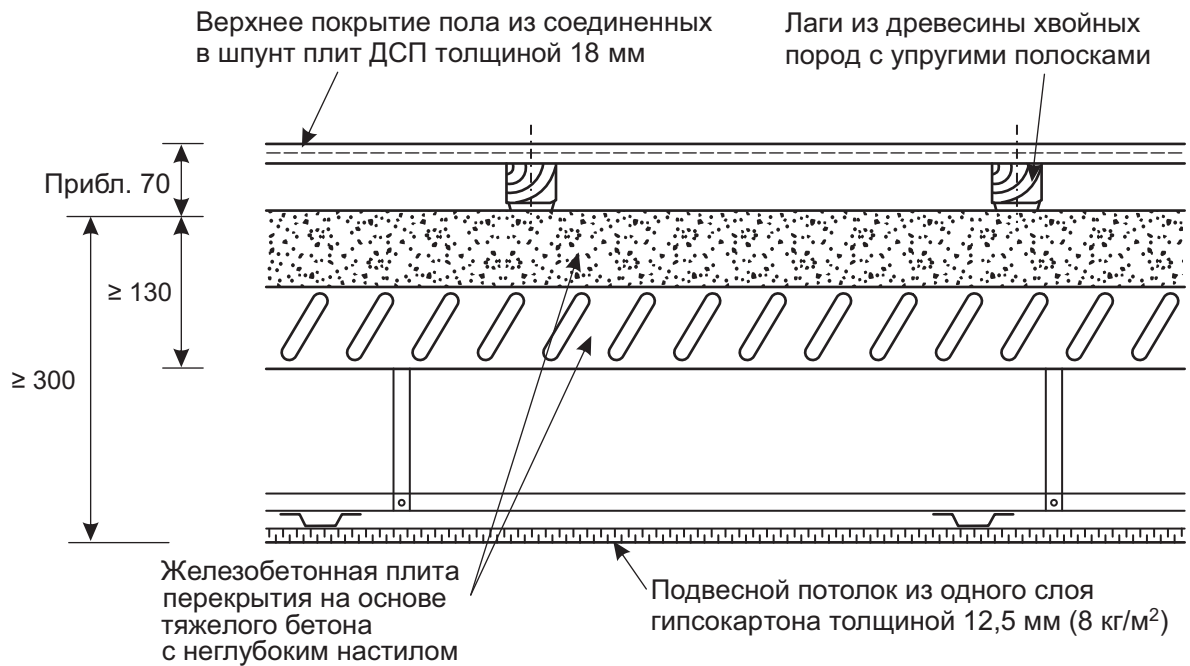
Типовая комбинированная плита перекрытия малой толщины с упругим покрытием на деревянных лагах (классифицируется как надежная конструкция)
